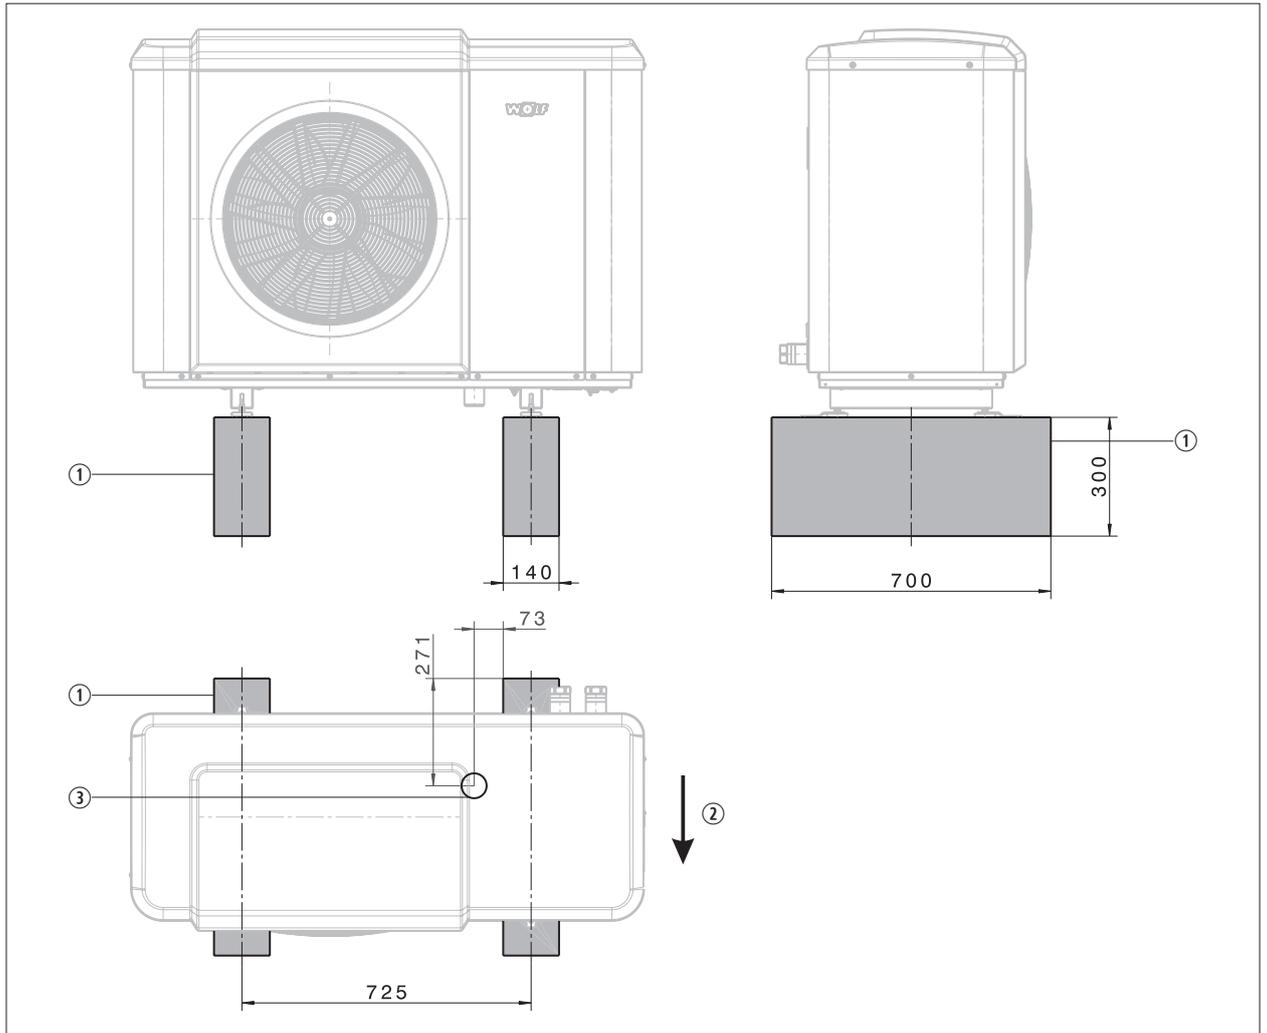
Fondazione continua per installazione diretta a pavimento
